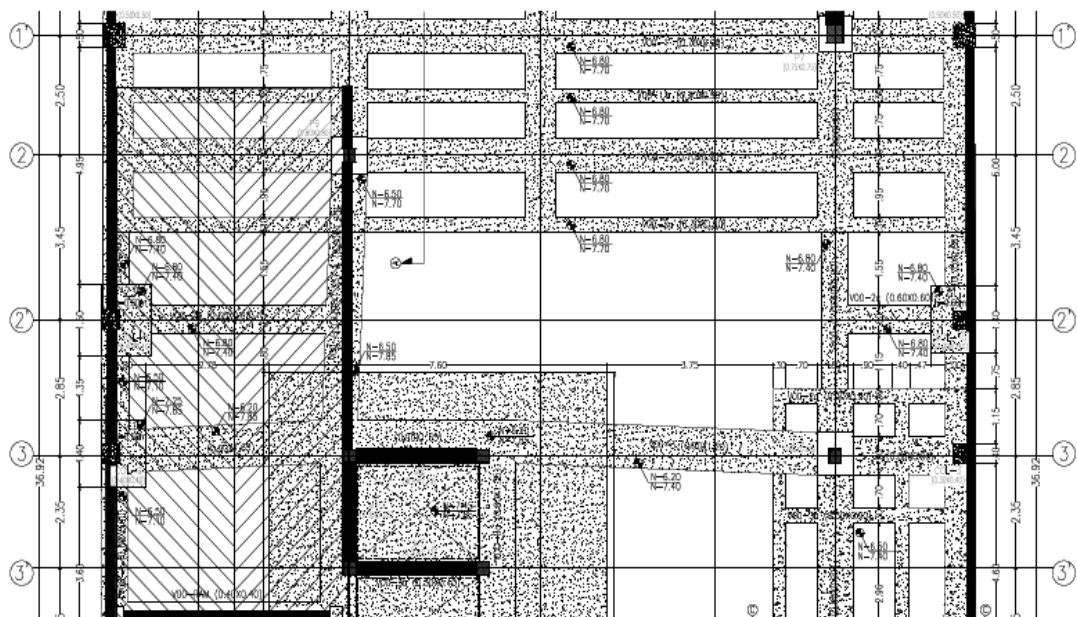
Plano de cimentación, sección 2. (De Oriente a Occidente eje 1' a 3')
